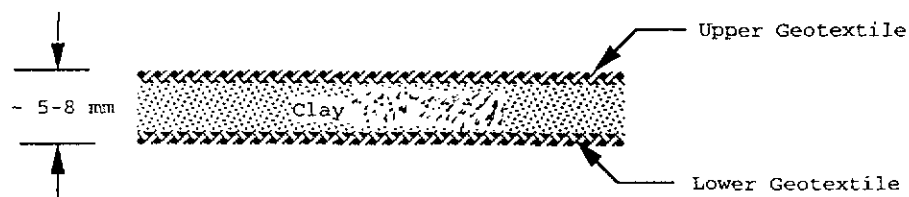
Tørr bentonitt mellom to lag geotekstiler bundet sammen med nålestukket fibre
